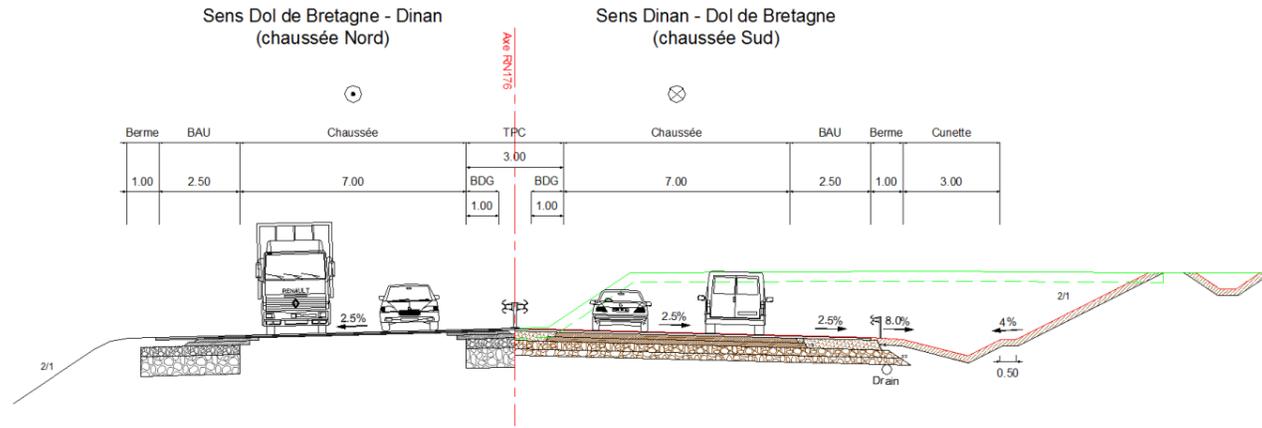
Profil en travers de la section courante en déblai (source ARCADIS)
